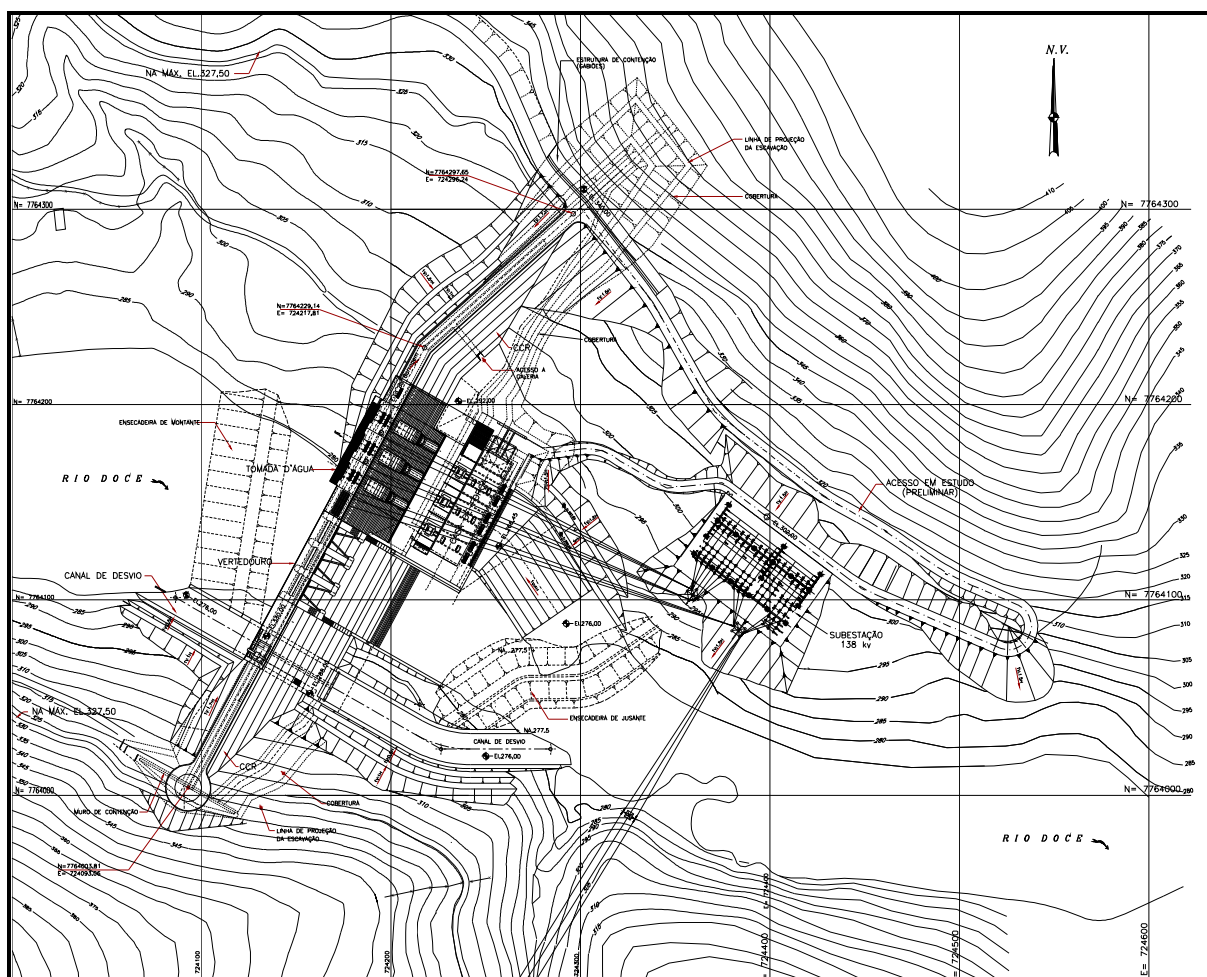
Arranjo geral da UHE Risoleta Neves.
